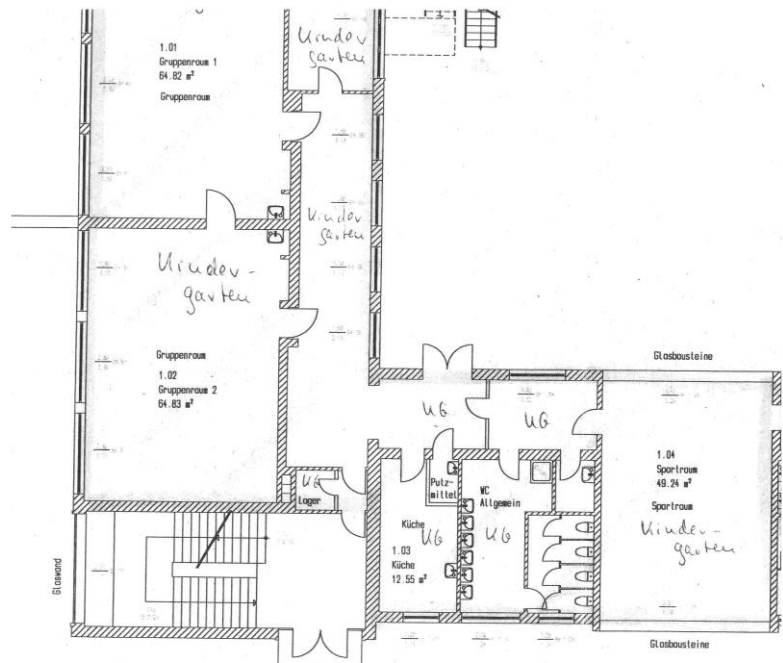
Grundriss (Erdgeschoss Vierbaum)
